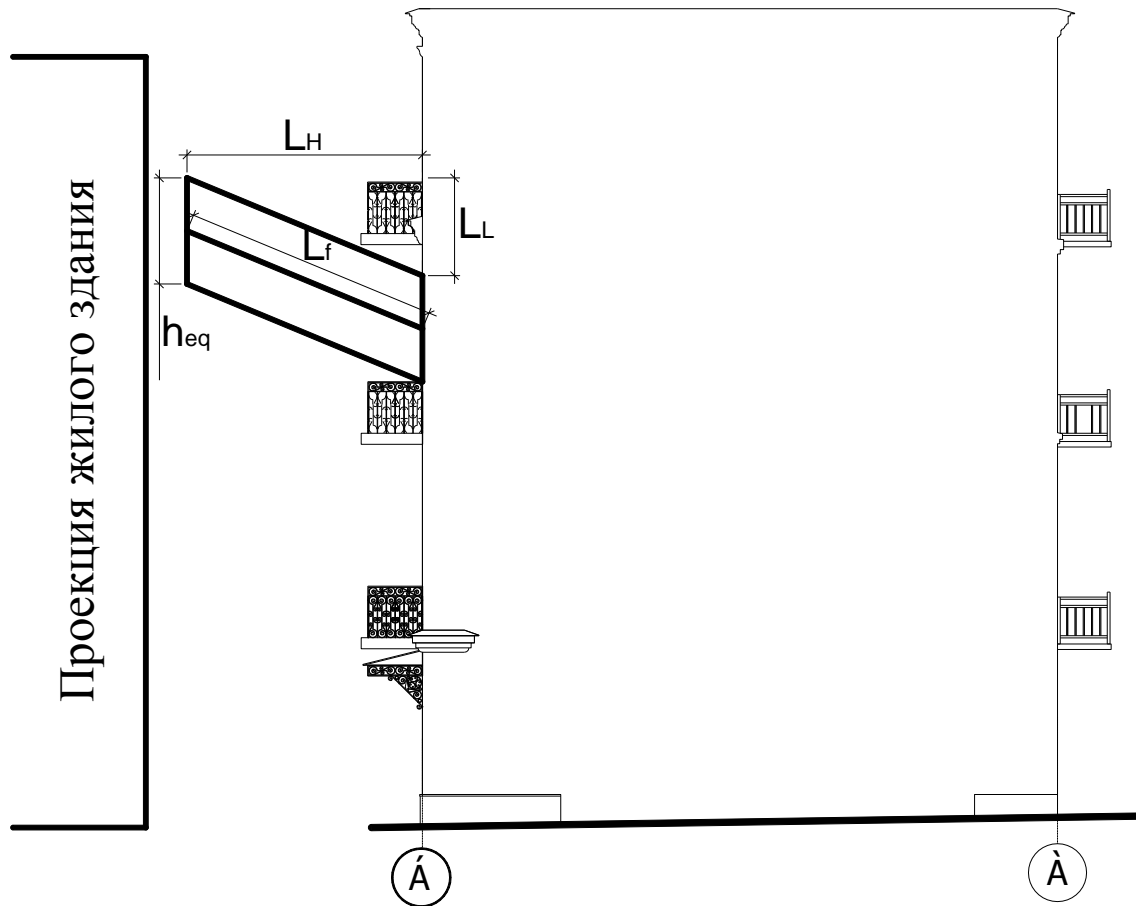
Вертикальная проекция пламени на фасаде здания
